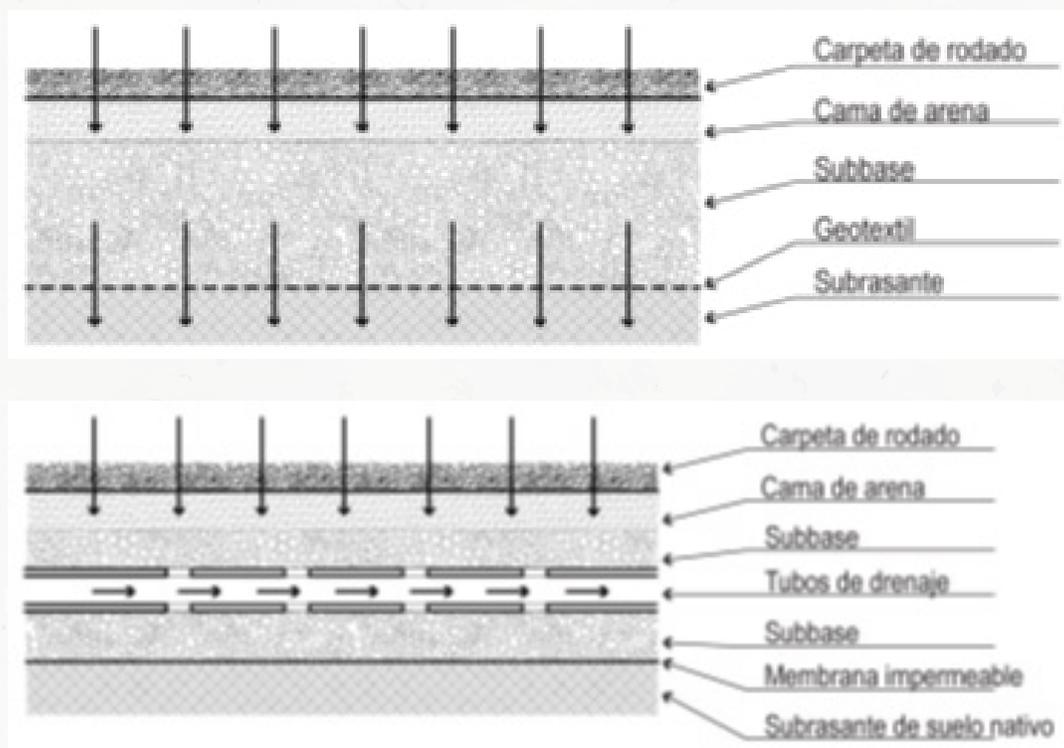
Pavimentos Permeables (Fuente: MOP-DOH, 2013)
